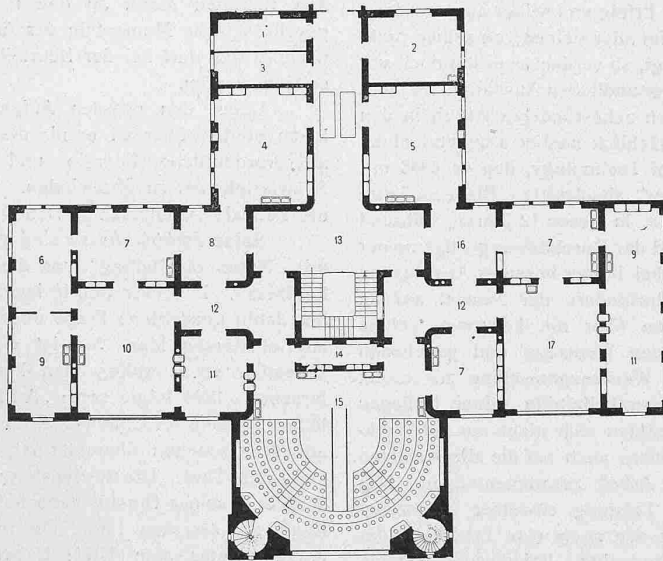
Grundriss vom II. Stock. — Masstab 1:500.
